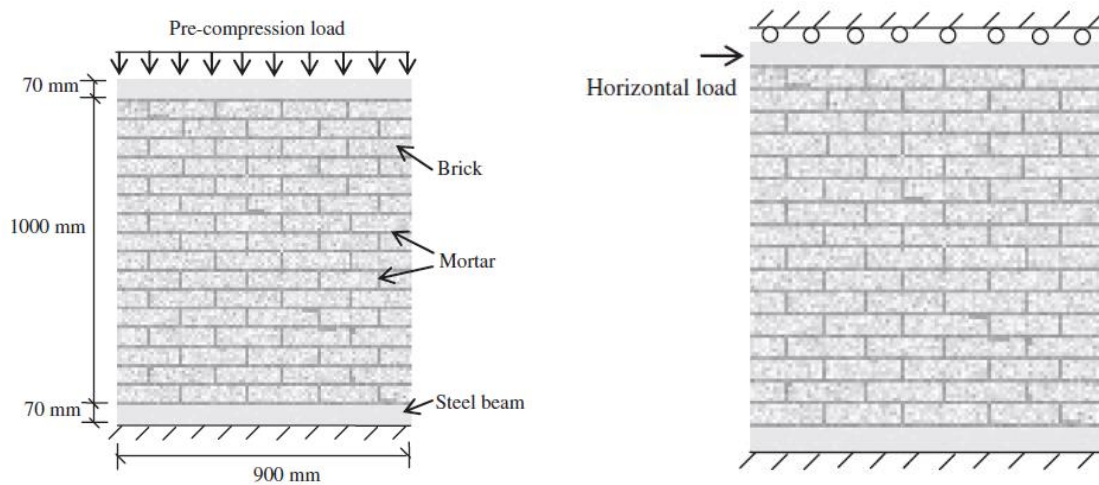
Modelación de muro de mampostería sujeto a carga axial y lateral (Xu et al., 2011).
